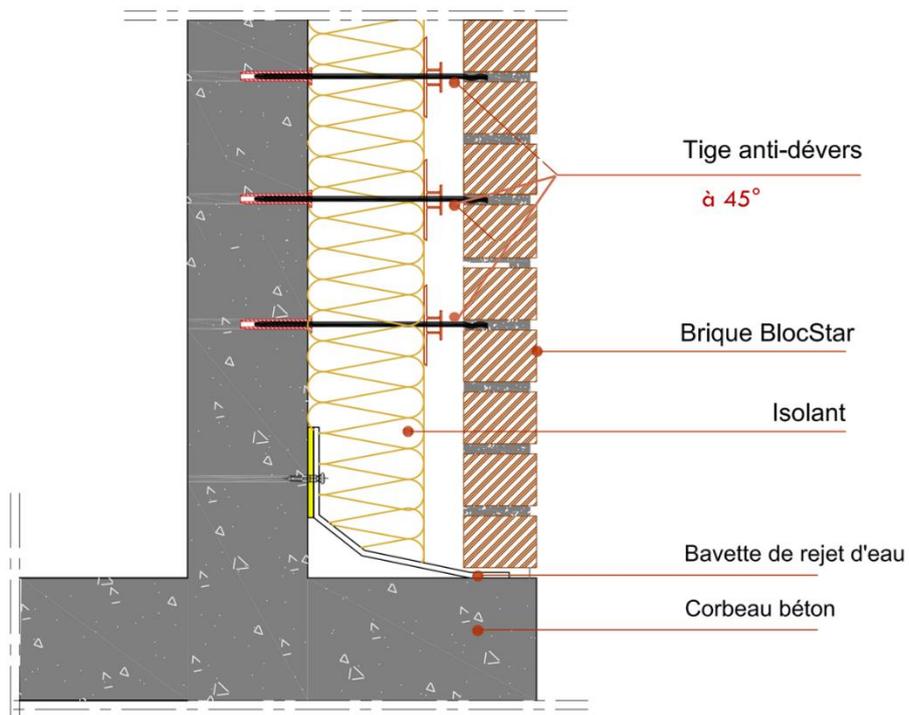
Appui du 1er rang sur fondation, dalle ou corbeau béton (1 seul niveau)
